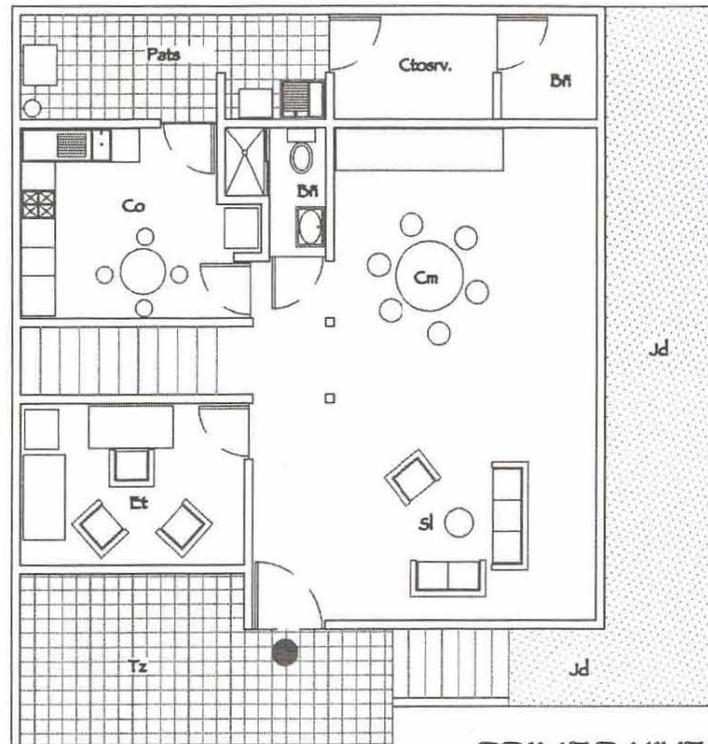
Levantamiento constructivo. Casa habitación de 1 nivel
